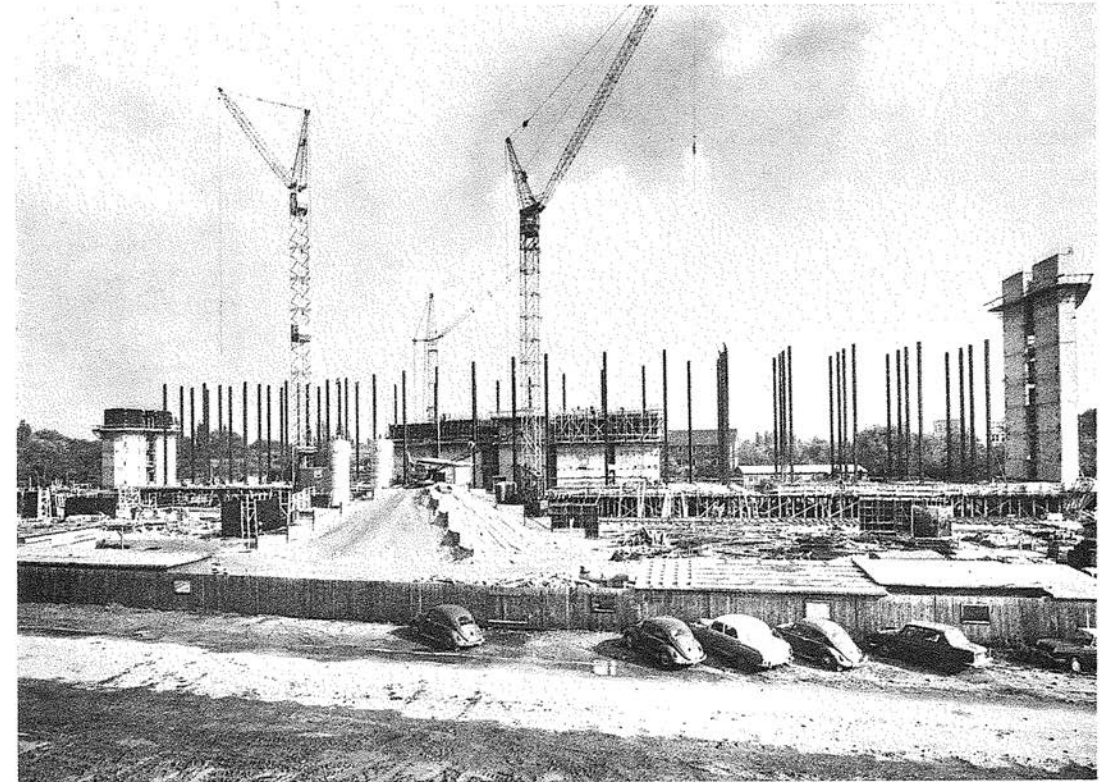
Nach Fertigstellung der ortsfest betonierten Kellerdecke werden die Stahlstützen montiert
